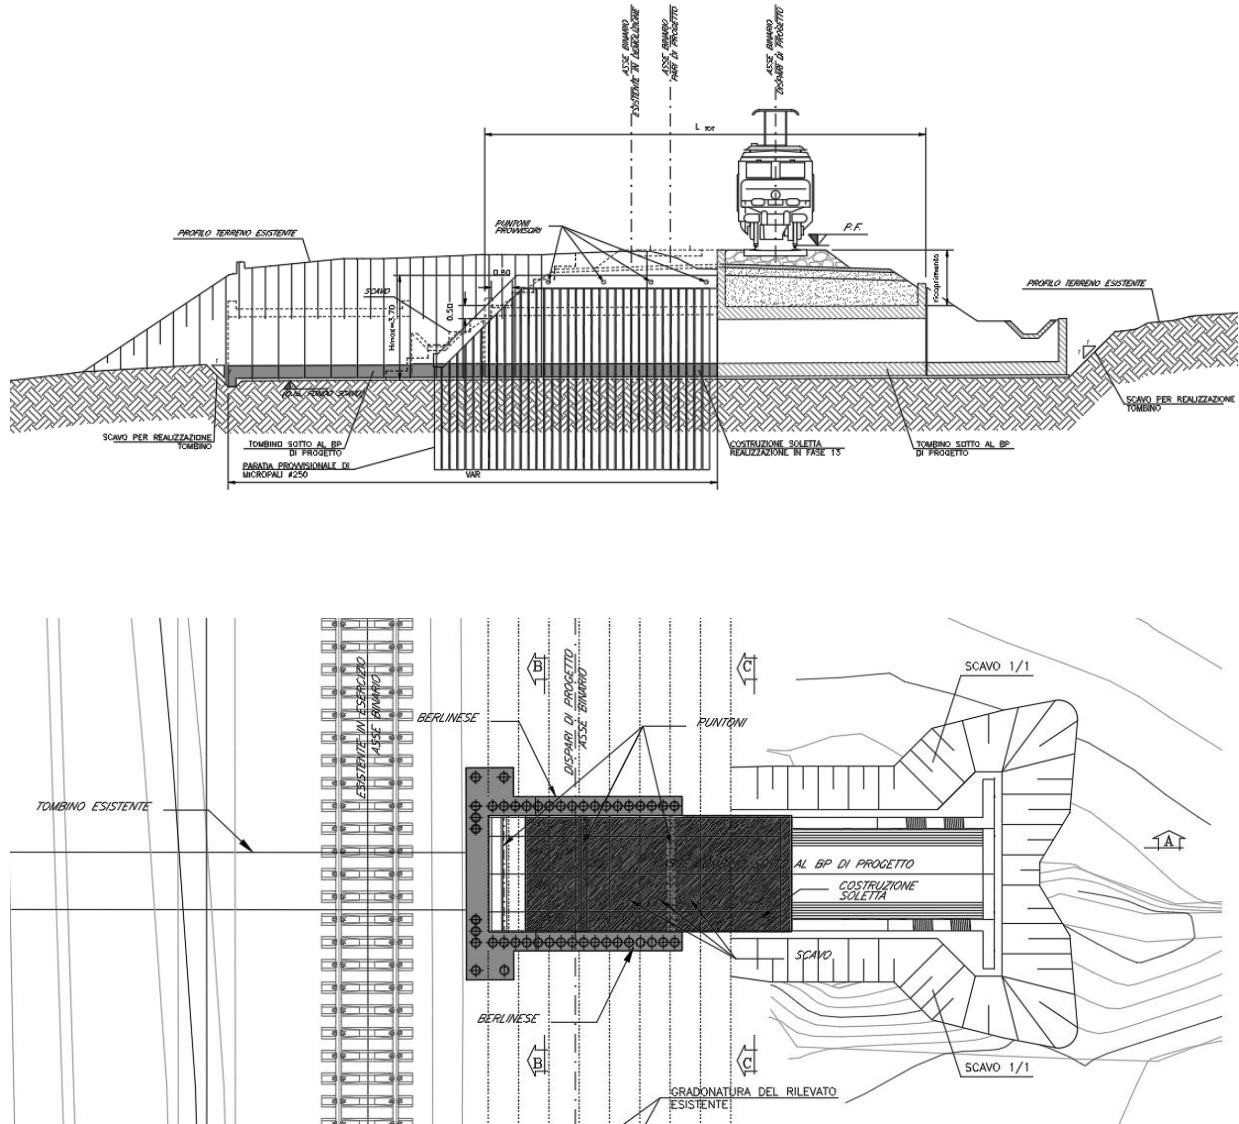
Paratia provvisoria: prospetto e rappresentazione schematica in pianta
